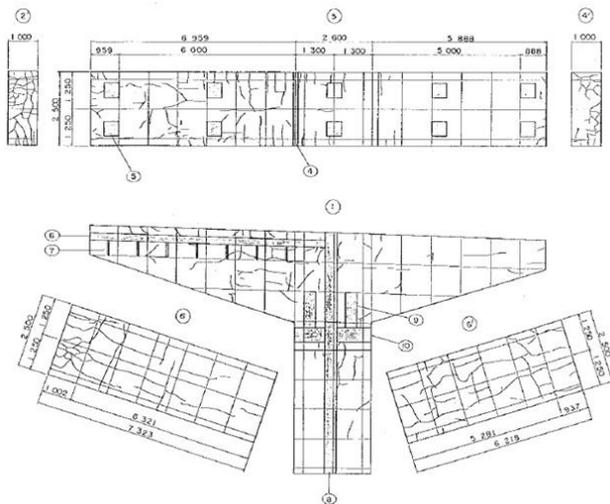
初回補修時ひび割れ図 (昭和 58 年)
